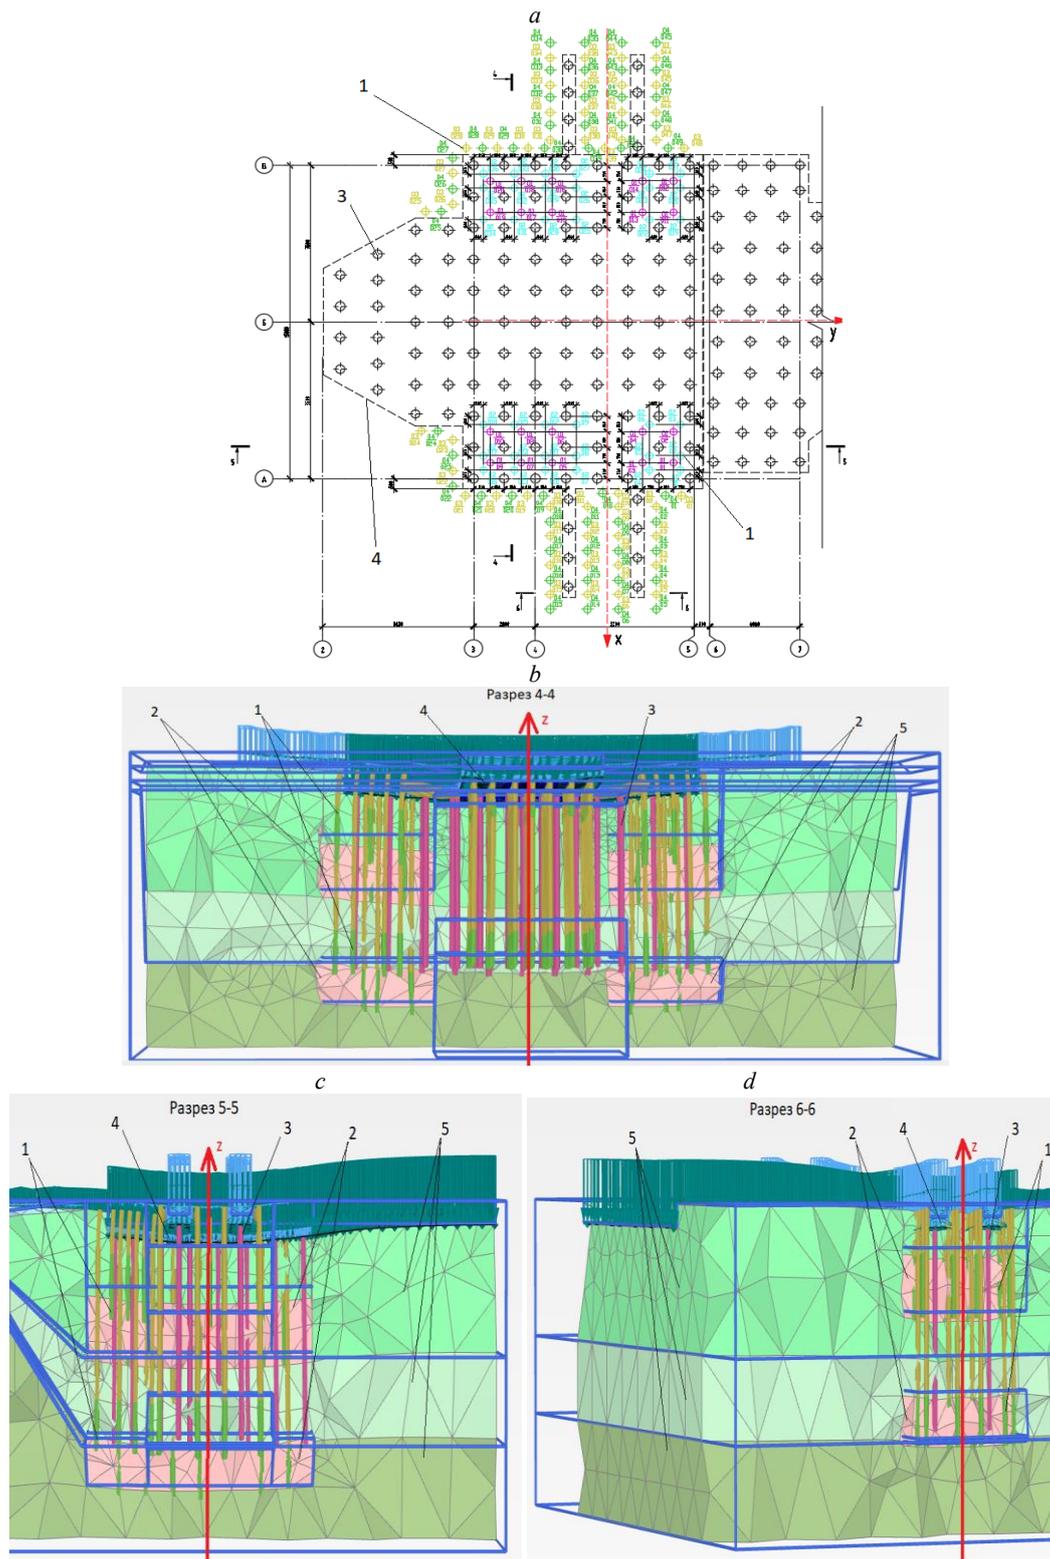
План (а) и разрезы геомеханической модели в Plaxis 3D (b, c) при закреплении: а – план фундаментов; b – поперечный разрез вентилятора главного проветривания; c – продольный разрез; d – поперечный разрез роствергов; 1 – инъекторы; 2 – зоны закрепления; 3 – сваи; 4 – фундамент; 5 – инженерно-геологические слои;
